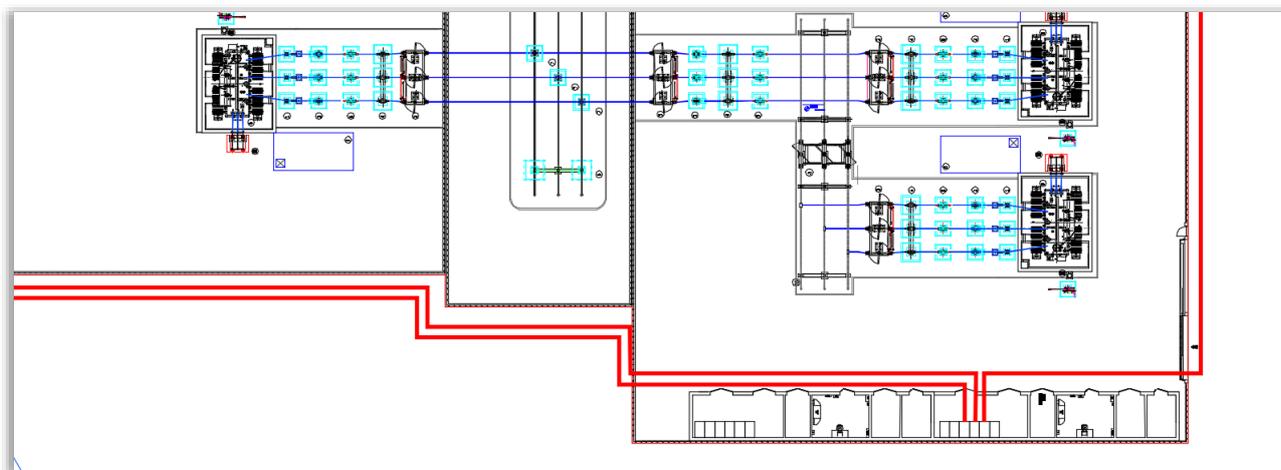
Planimetria elettromeccanica della SSE, con stralcio dello stallo di connessione dell'impianto in esame.
